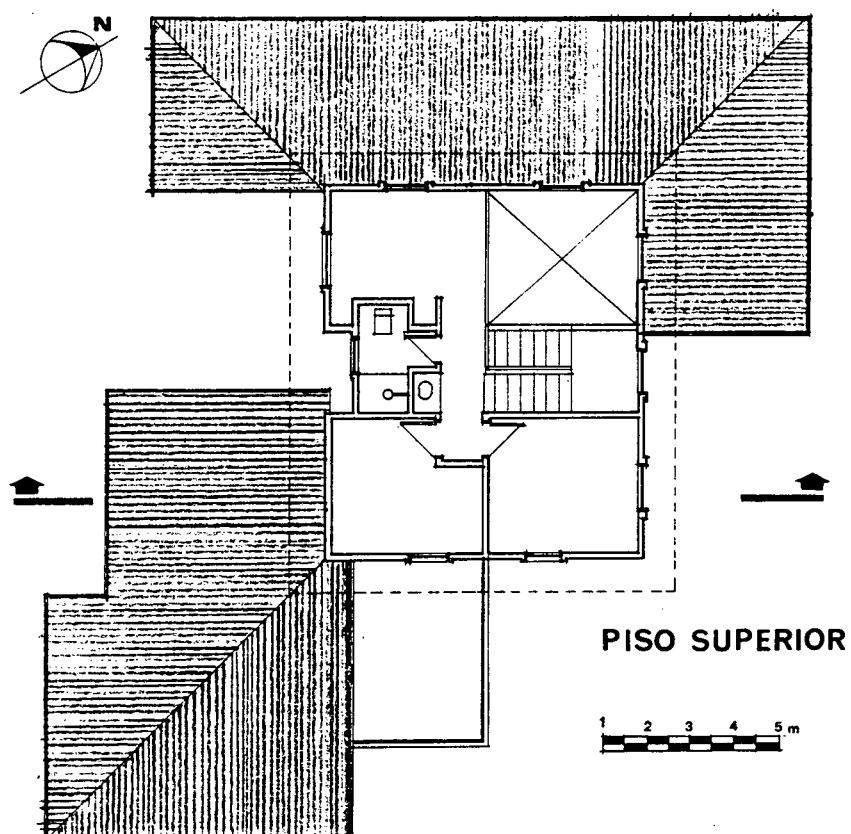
Planta do pavimento superior da casa nº3 (Campeche)
